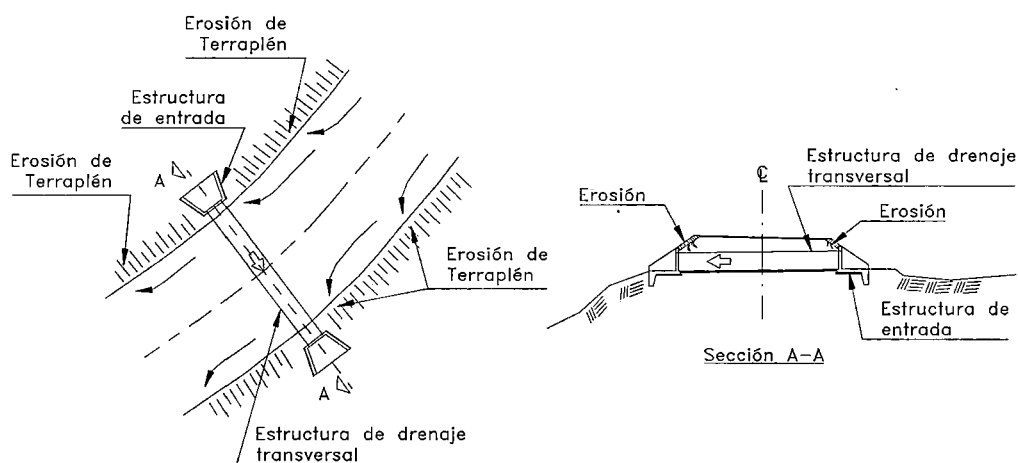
Erosión en el Terraplén cerca de la Estructura de Drenaje Transversal Debido al flujo del Sistema de Drenaje Longitudinal.
